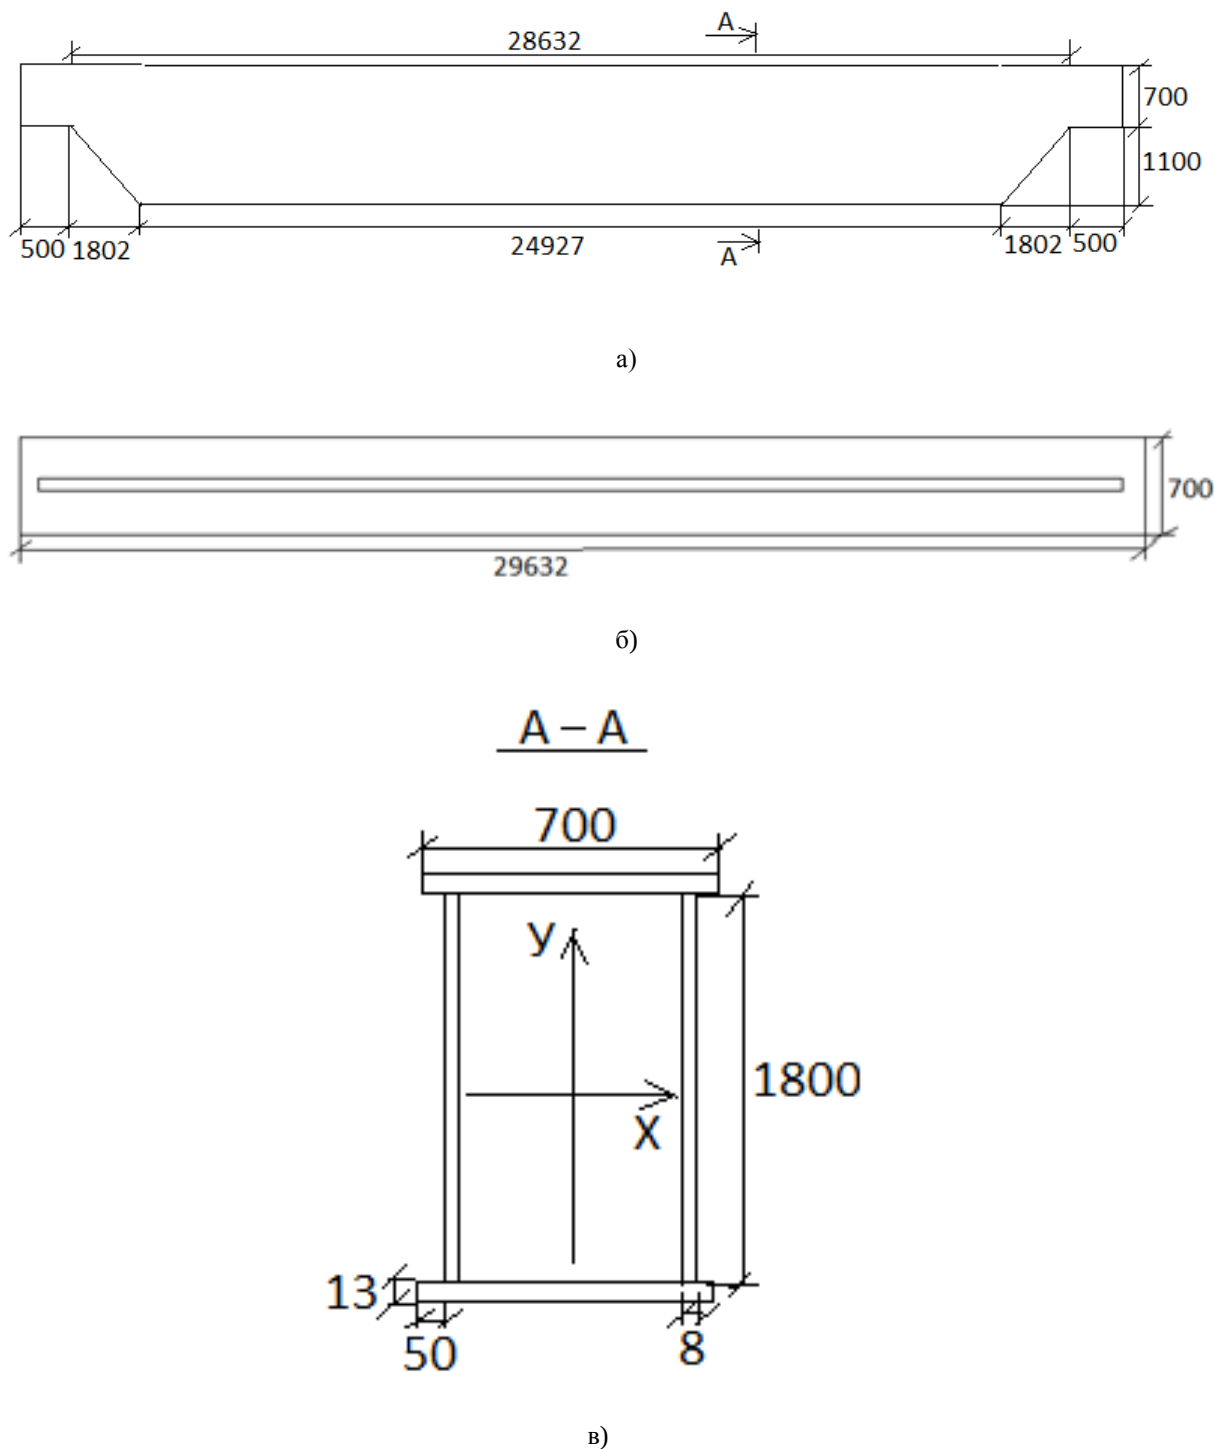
Схема балки и ее сечение [The beam scheme and its section]
